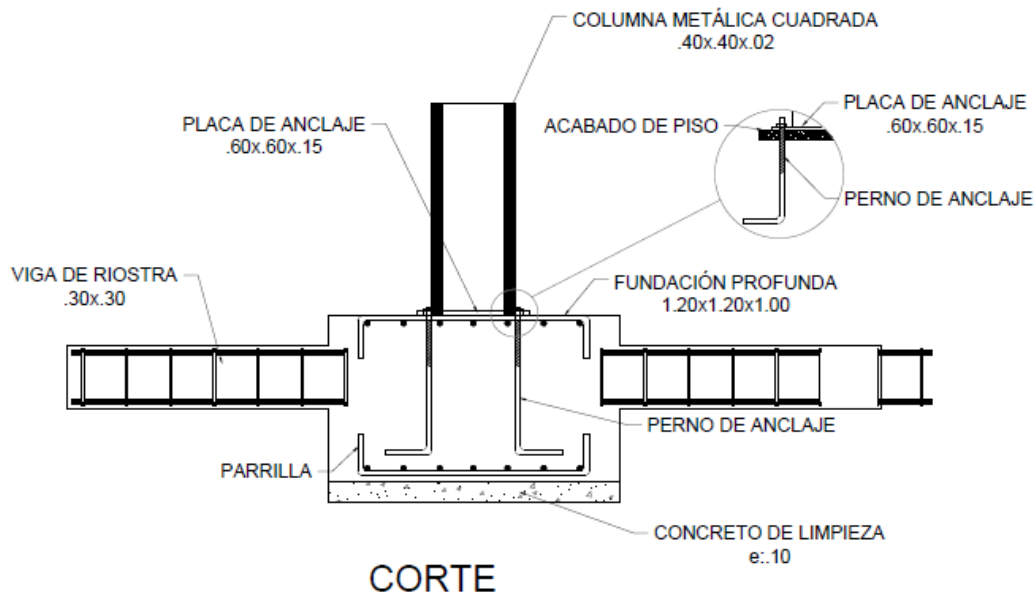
Fundación. Fuente: Michelle Thielen 2021.
